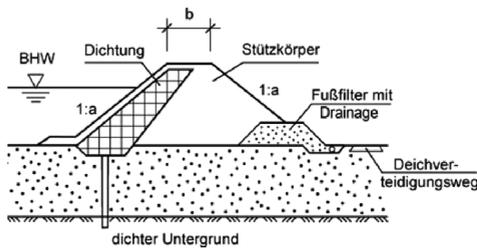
Möglichkeiten zur Sanierung von bestehenden Hochwasserschutzdämmen (nach [6])
